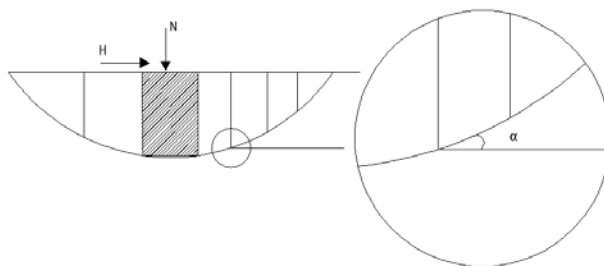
Расчетная схема фундамента с учетом анизотропии прочностных свойств грунта:
